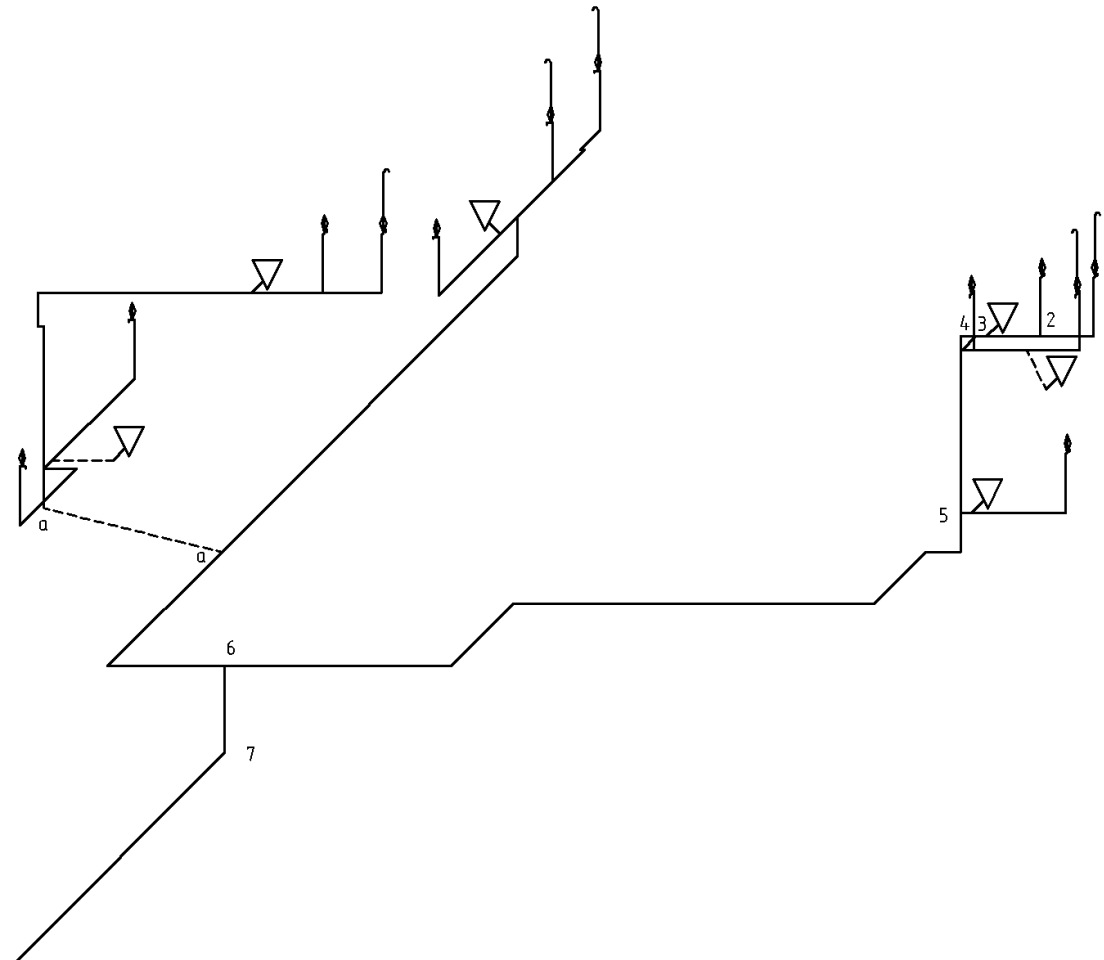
Расчётная схема системы холодного водоснабжения
